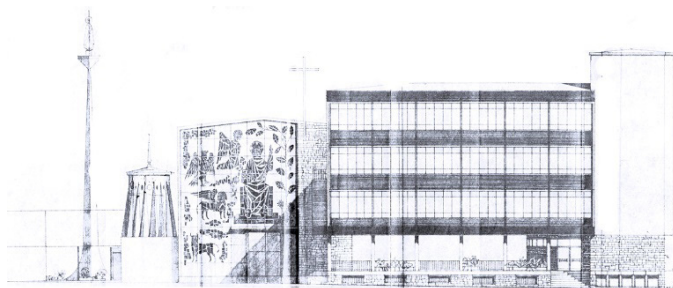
Plano de alzado del Conjunto Parroquial. Percepción del diseño original de la vidriera
